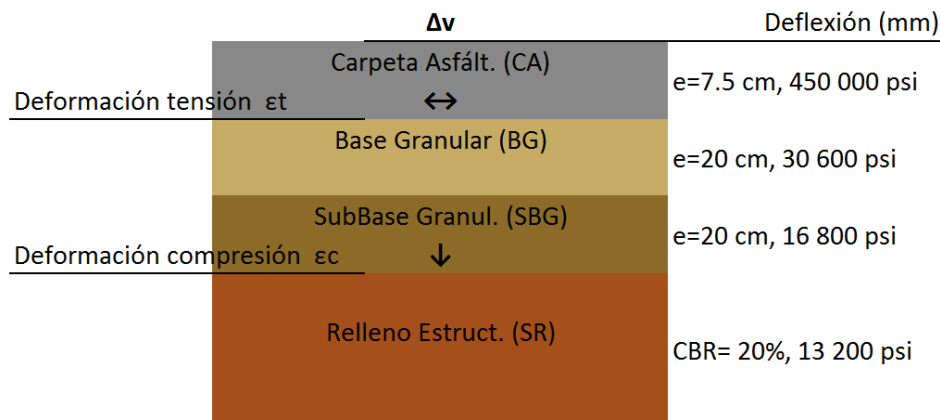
Sección de pavimento construido Km 100+480 - 136+000
